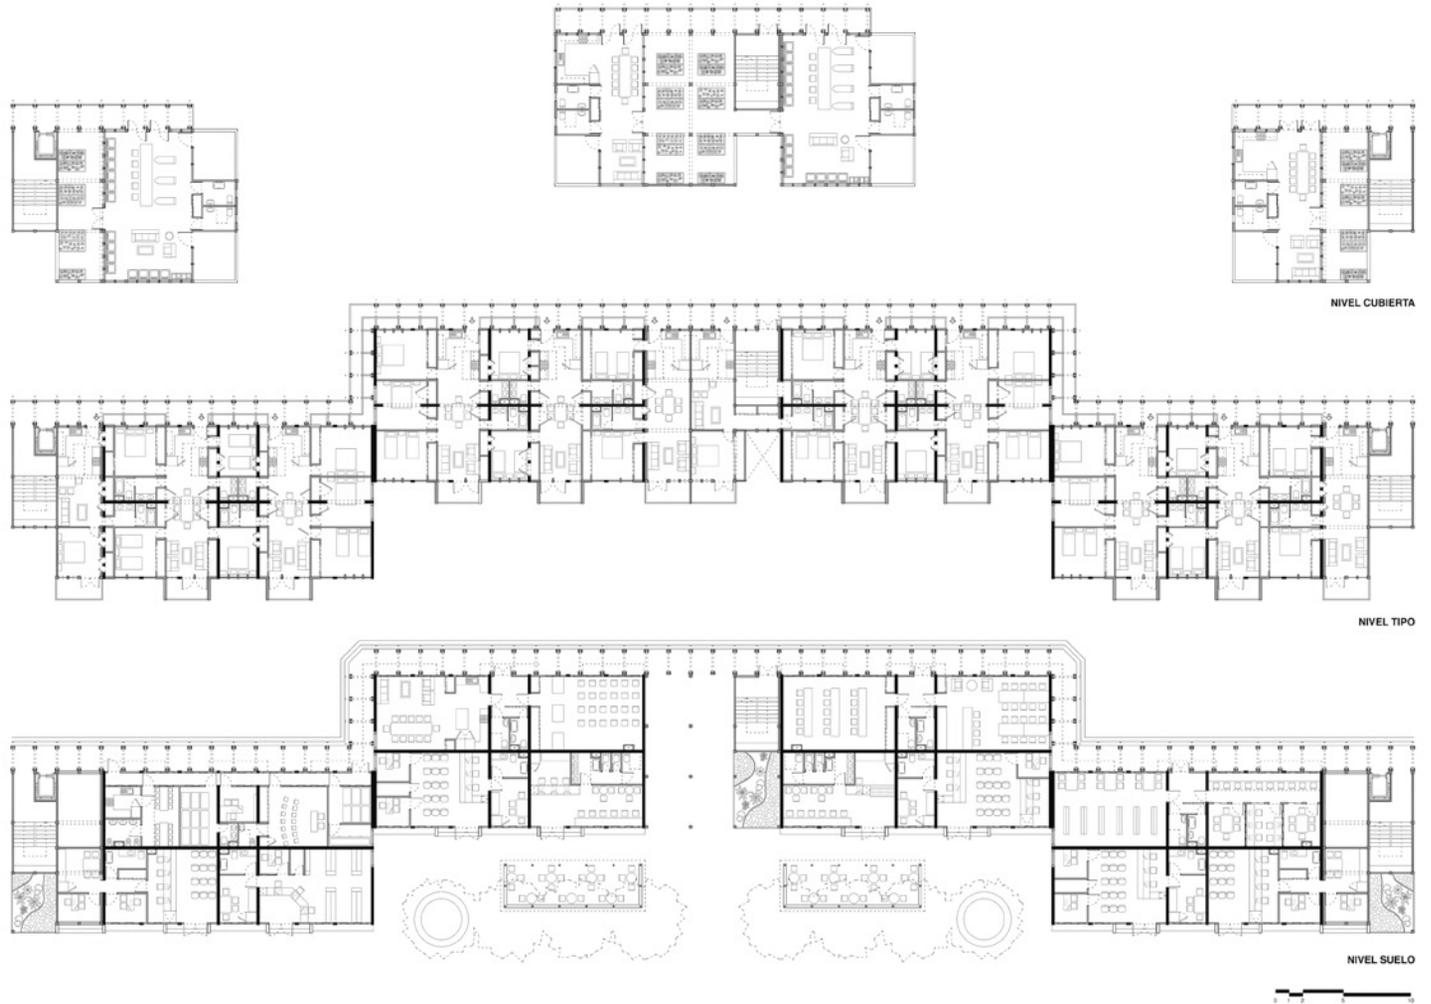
Planimetrías generales de nivel cubierta, nivel tipo y nivel suelo. Fuente: elaboración propia.
